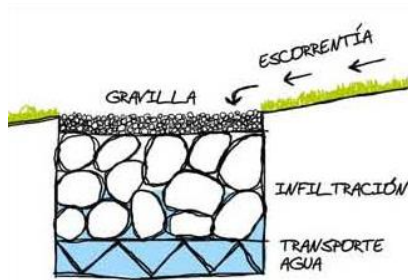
Detalle de dren filtrante sin tubo drenante en su interior.
